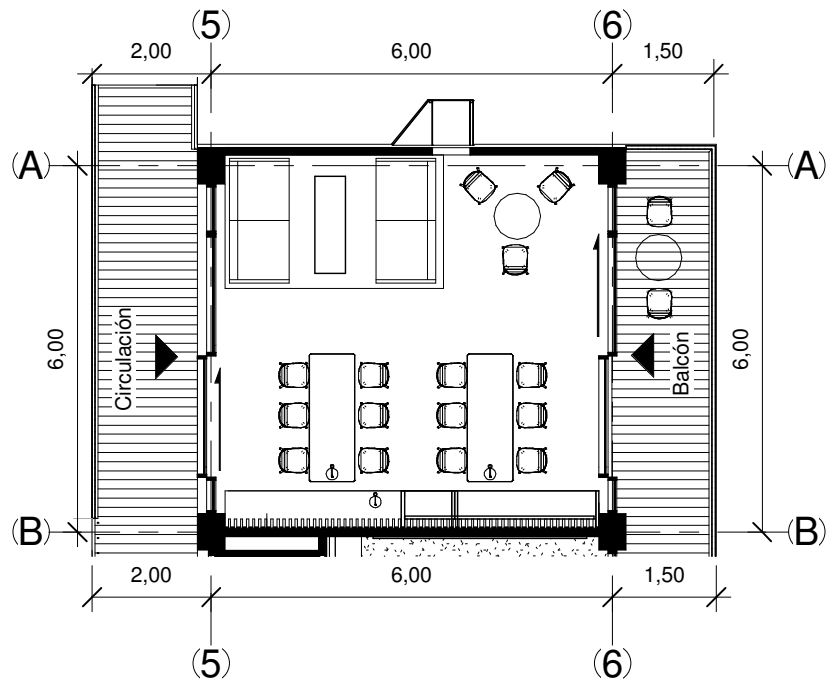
Ampliación planta salón recreativo. Fuente propia.
